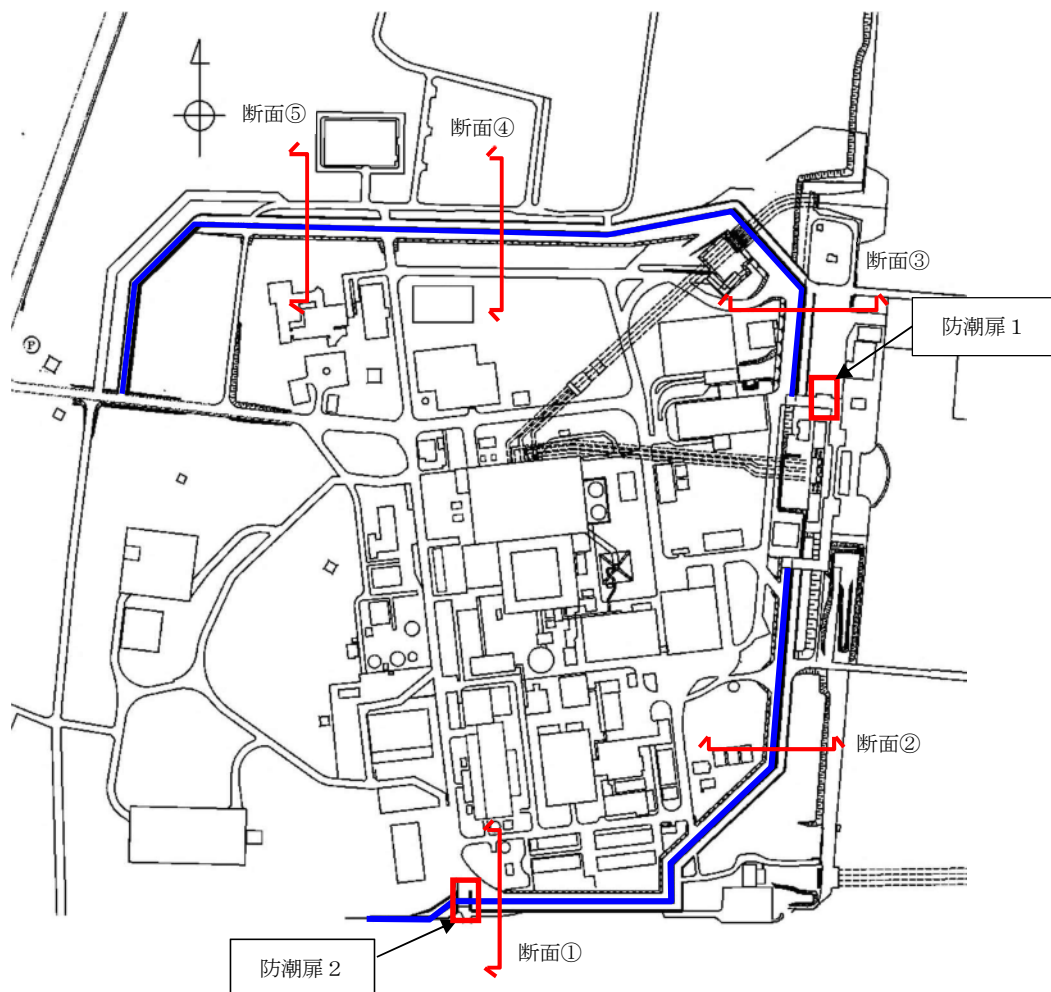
防潮扉および鋼管杭鉄筋コンクリート防潮堤評価対象断面位置図
